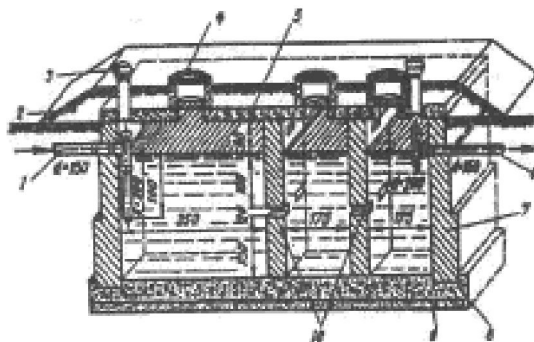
Тришкамерний септик: 1 – підвідна труба, 2 – насип, 3 – труба з отвором для прочистки, 4 – люк 5 – перекриття, 6 – відвідна труба, 7 – кладка, 8 – бетонна основа, 9. – основа із щебеня, 10 – отвір для проходження рідкої фази
